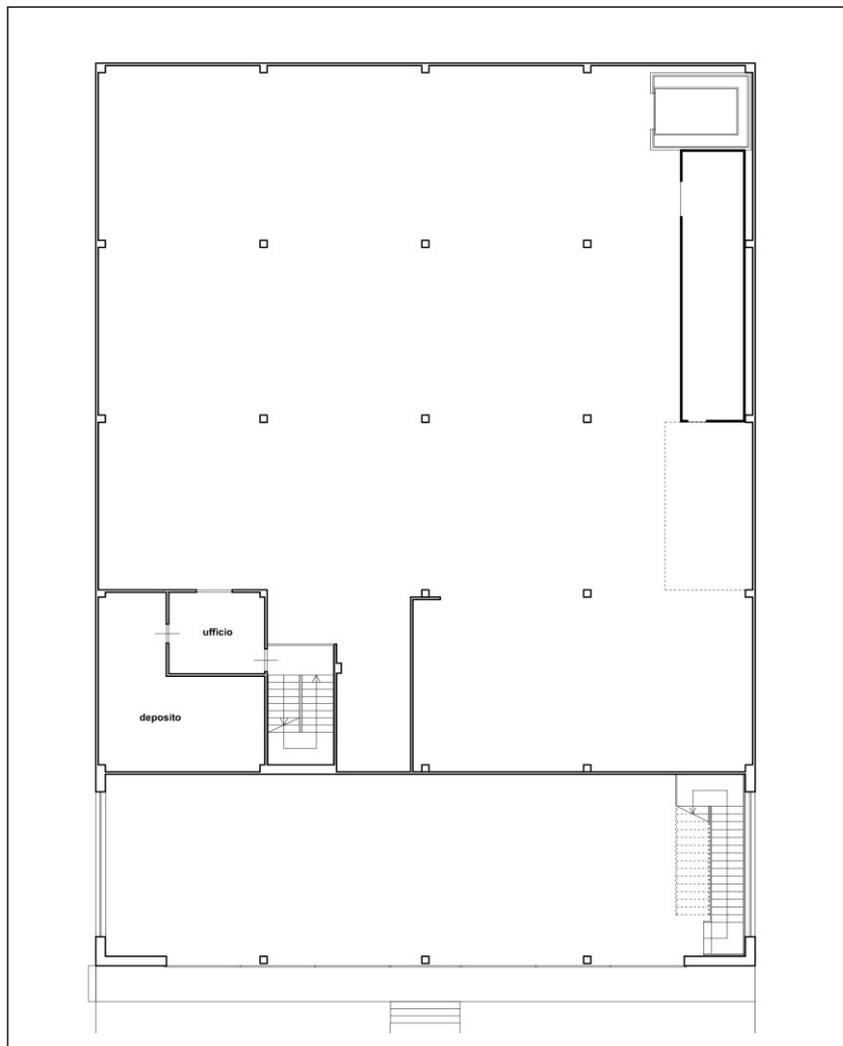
Rilievo dello stato di fatto del piano ammezzato.
